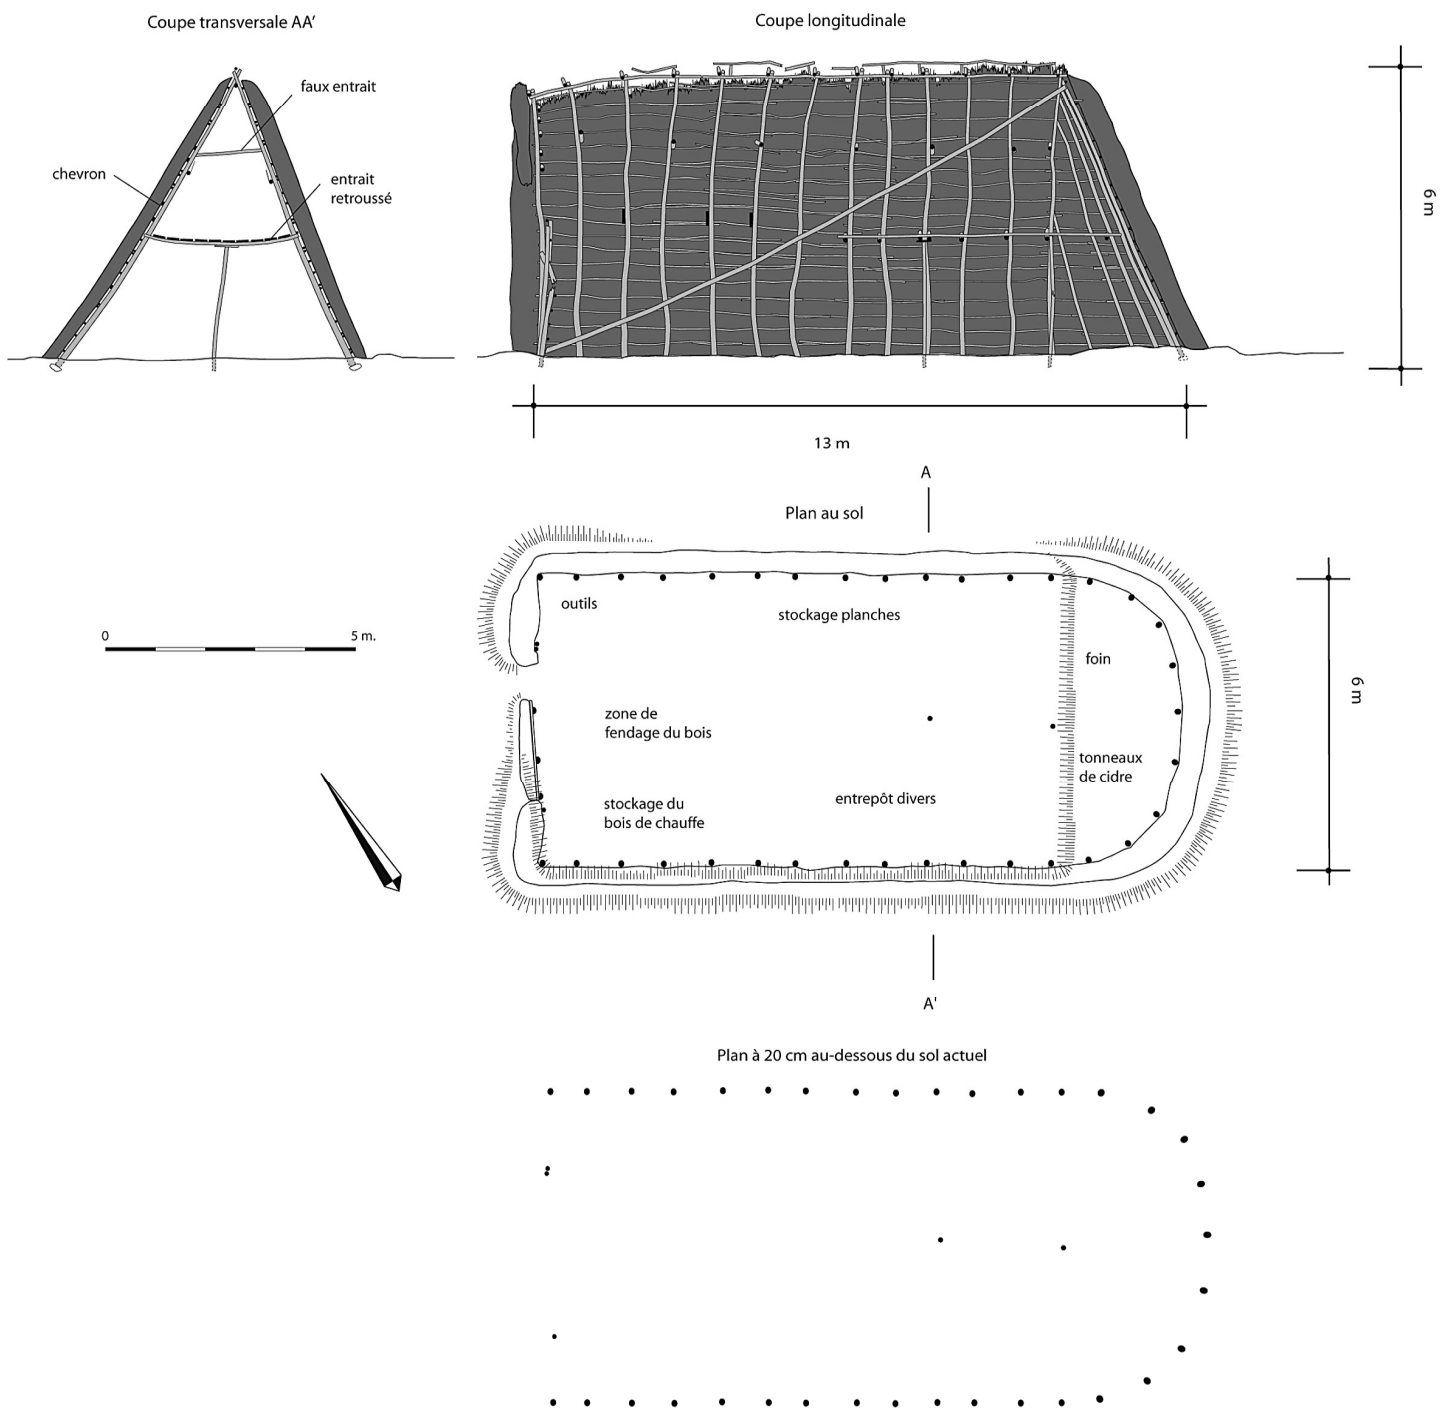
Ambillou, « La Chaussée ». Coupes et plan (relevé et dessin F. É.).
